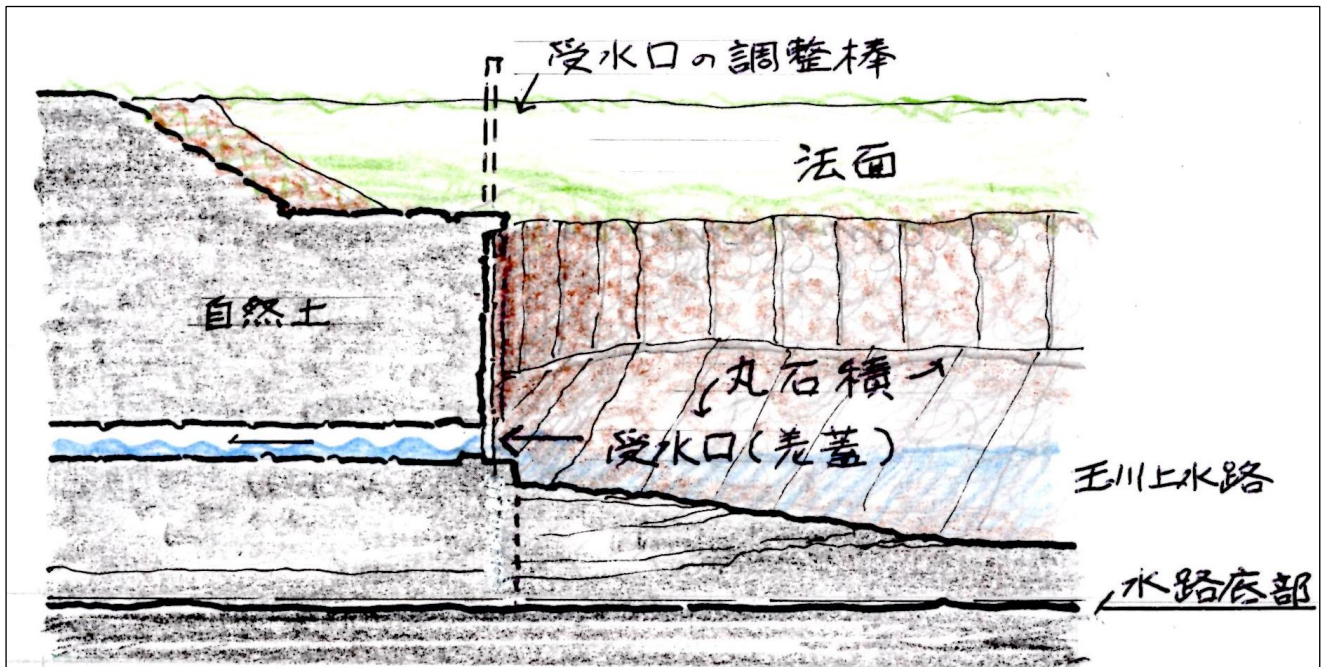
牟礼分水路取水口付近の略断面図
